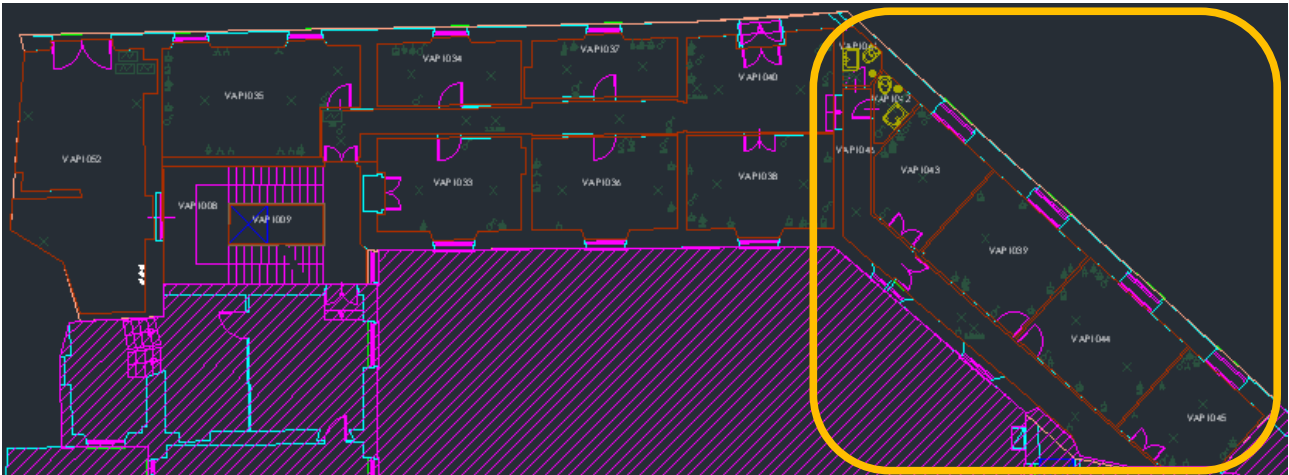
Locali di via Grenchen sede degli interventi del progetto
